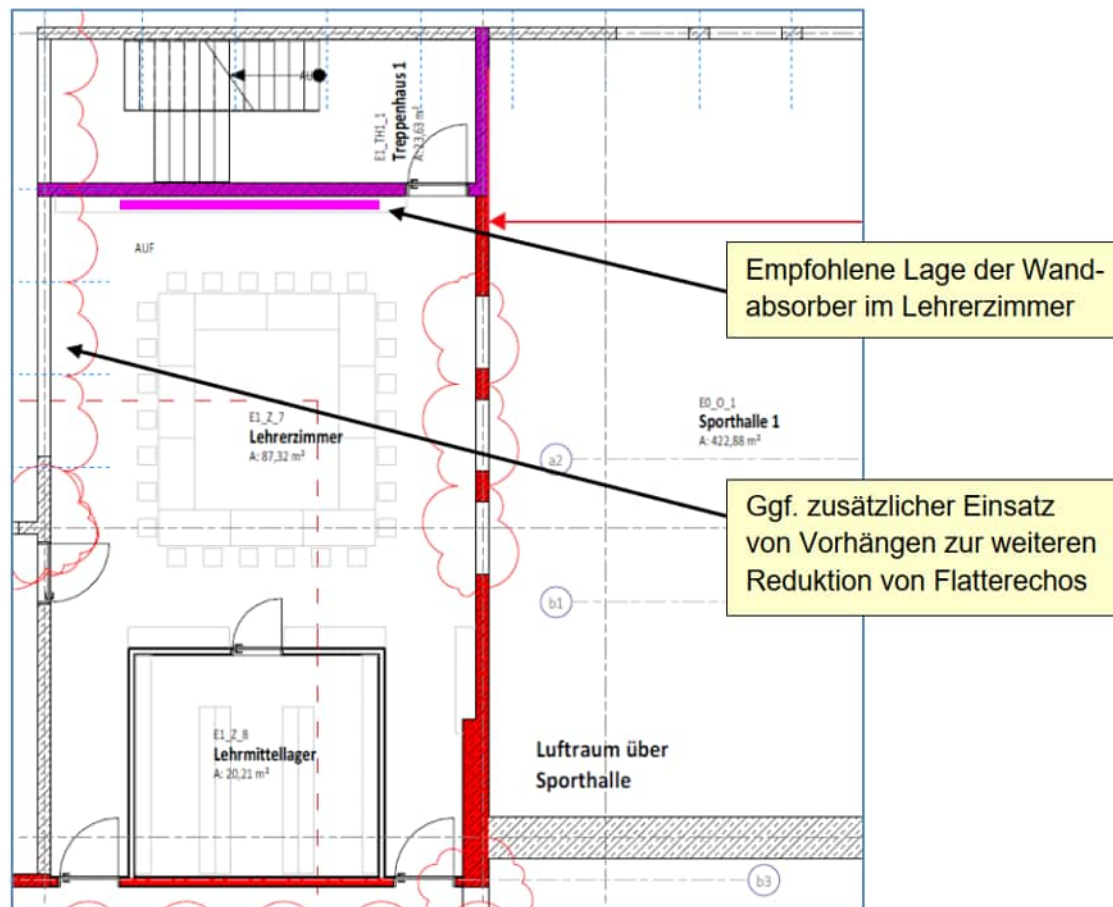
Grundrissauszug Lehrerzimmer 1. OG (schematische Darstellung)
